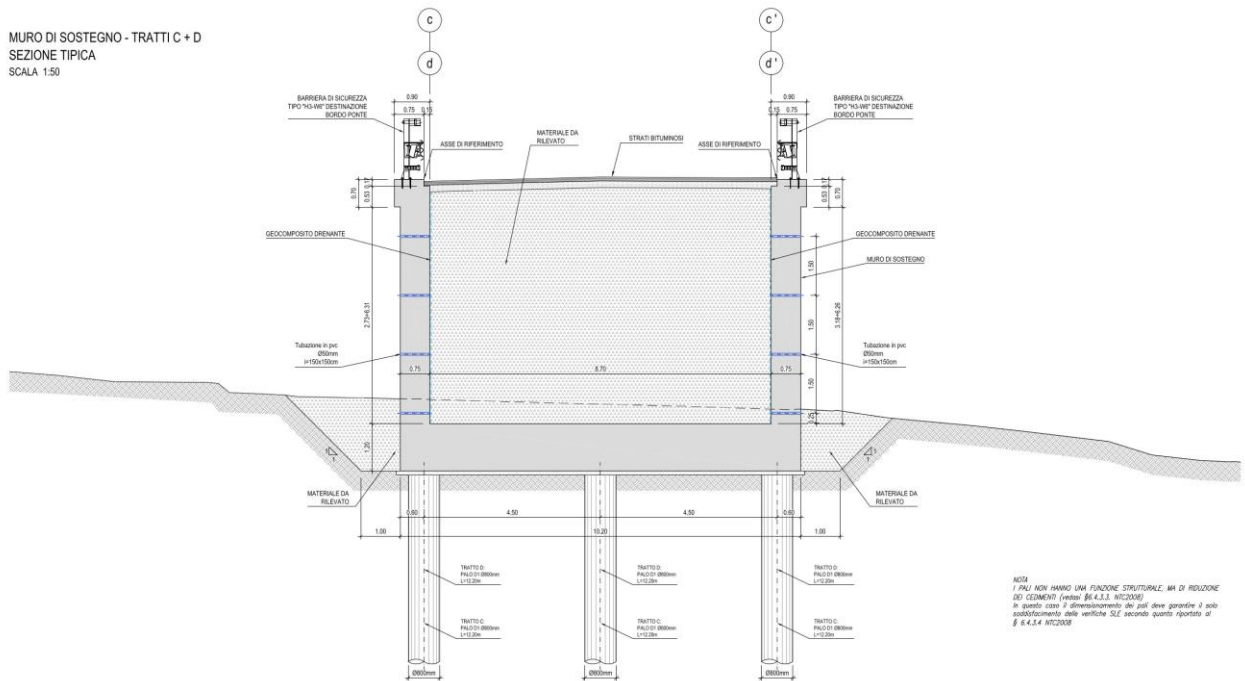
Sezione tipica muro ad U su pali di consolidamento
